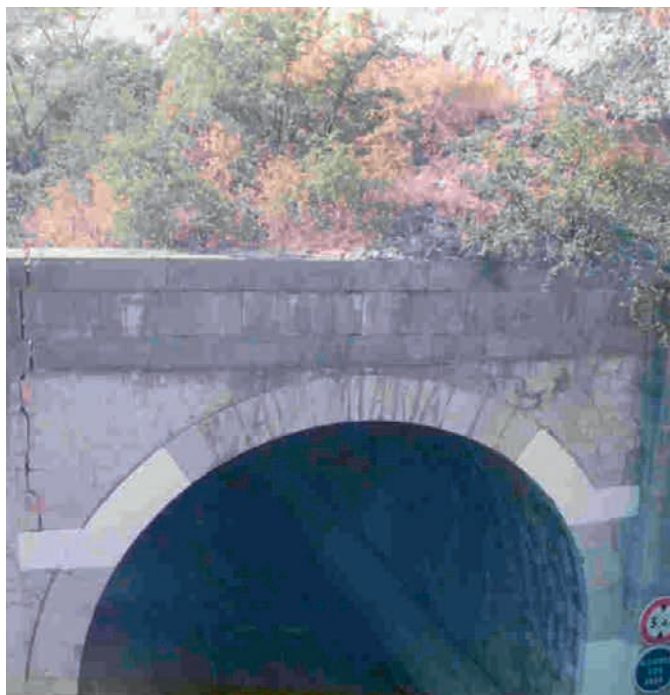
fissuration et basculement latéral d'un mur tympan, chambre d'éboulis non curée
